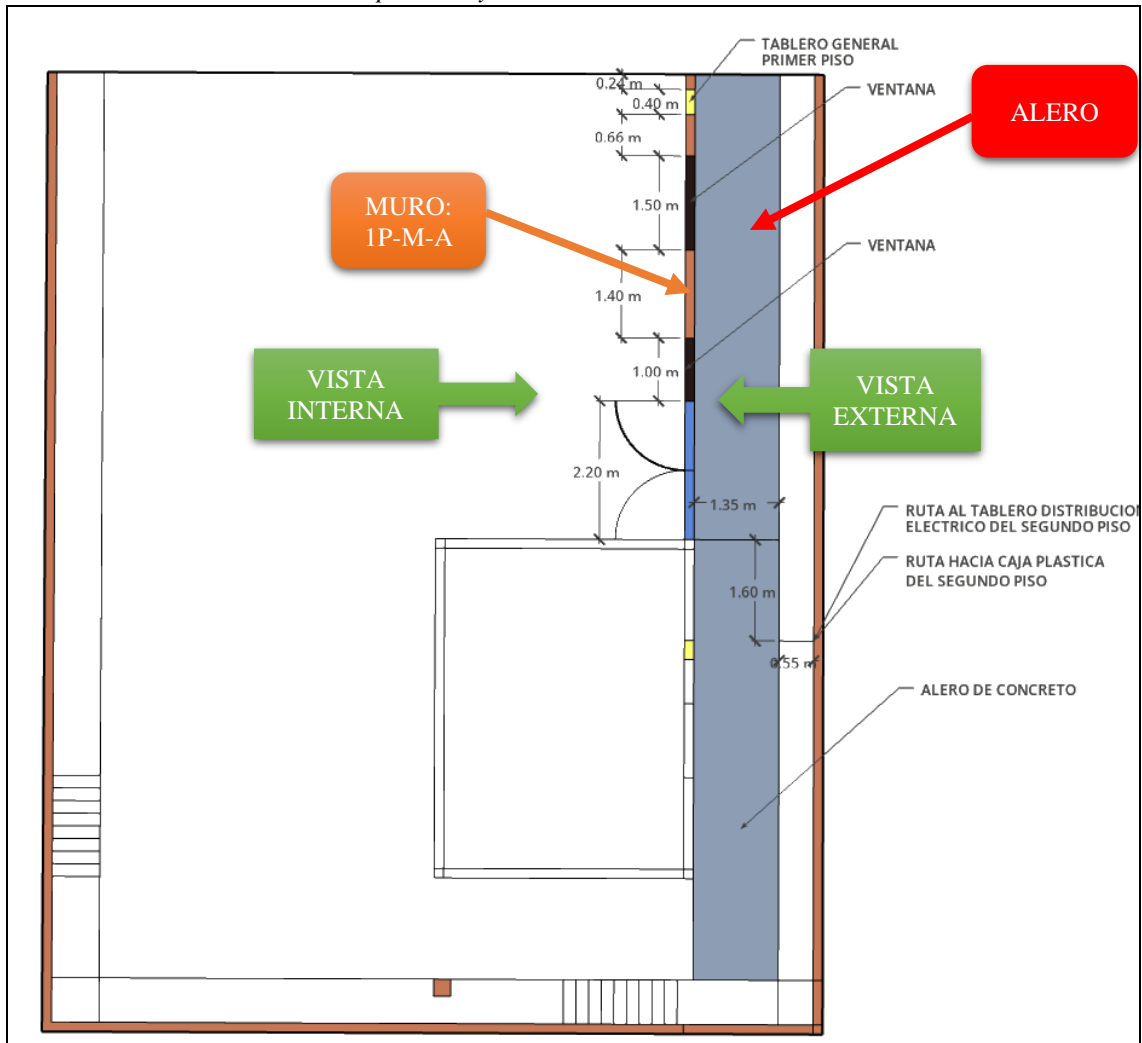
Plano de distribución del primer piso para la instalación del sistema eléctrico.
